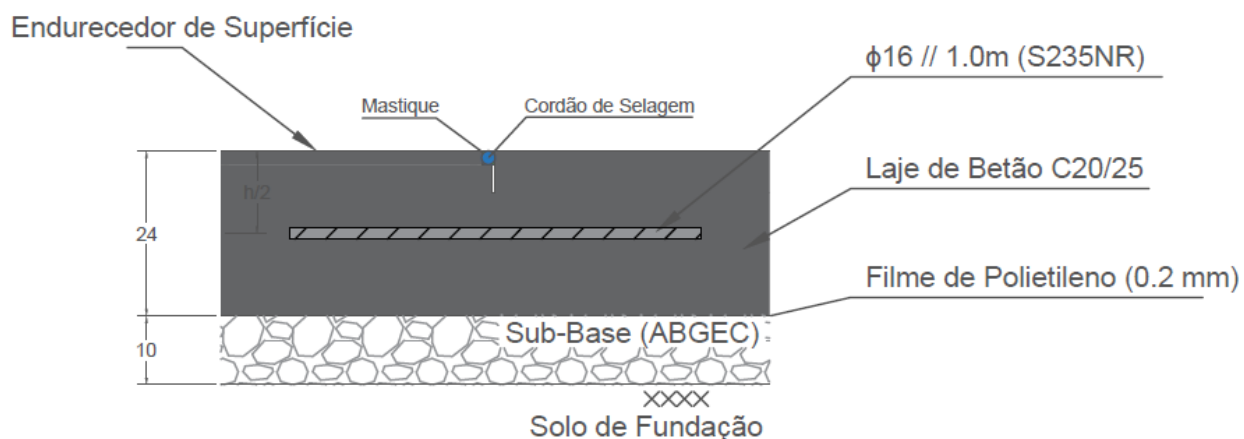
Exemplo de um pormenor de um pavimento rígido com passadores
